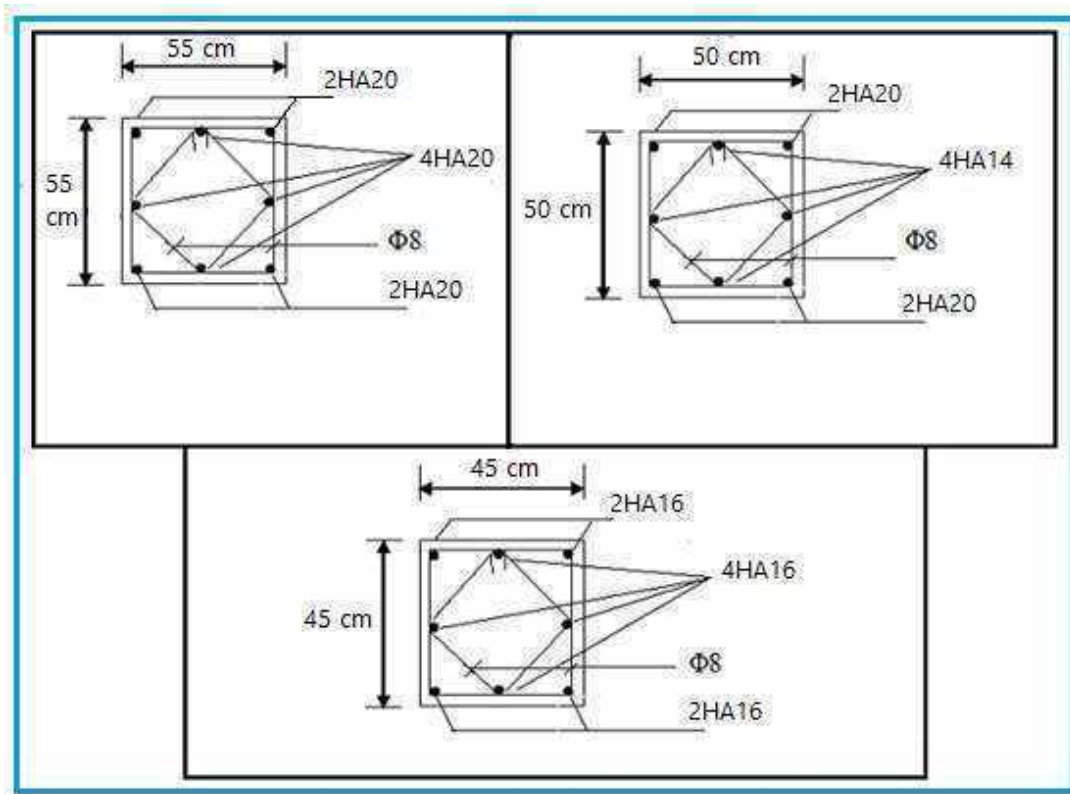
Schéma de ferrailage des Poteaux carrés.
